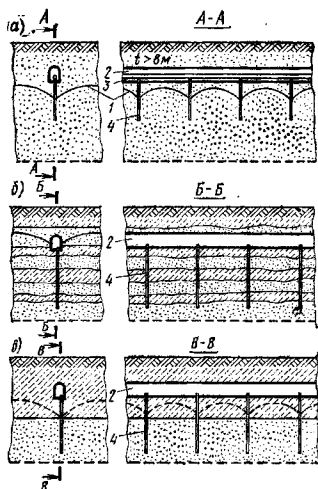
Схемы геологических условий, допускающих применение вертикального дренажа
